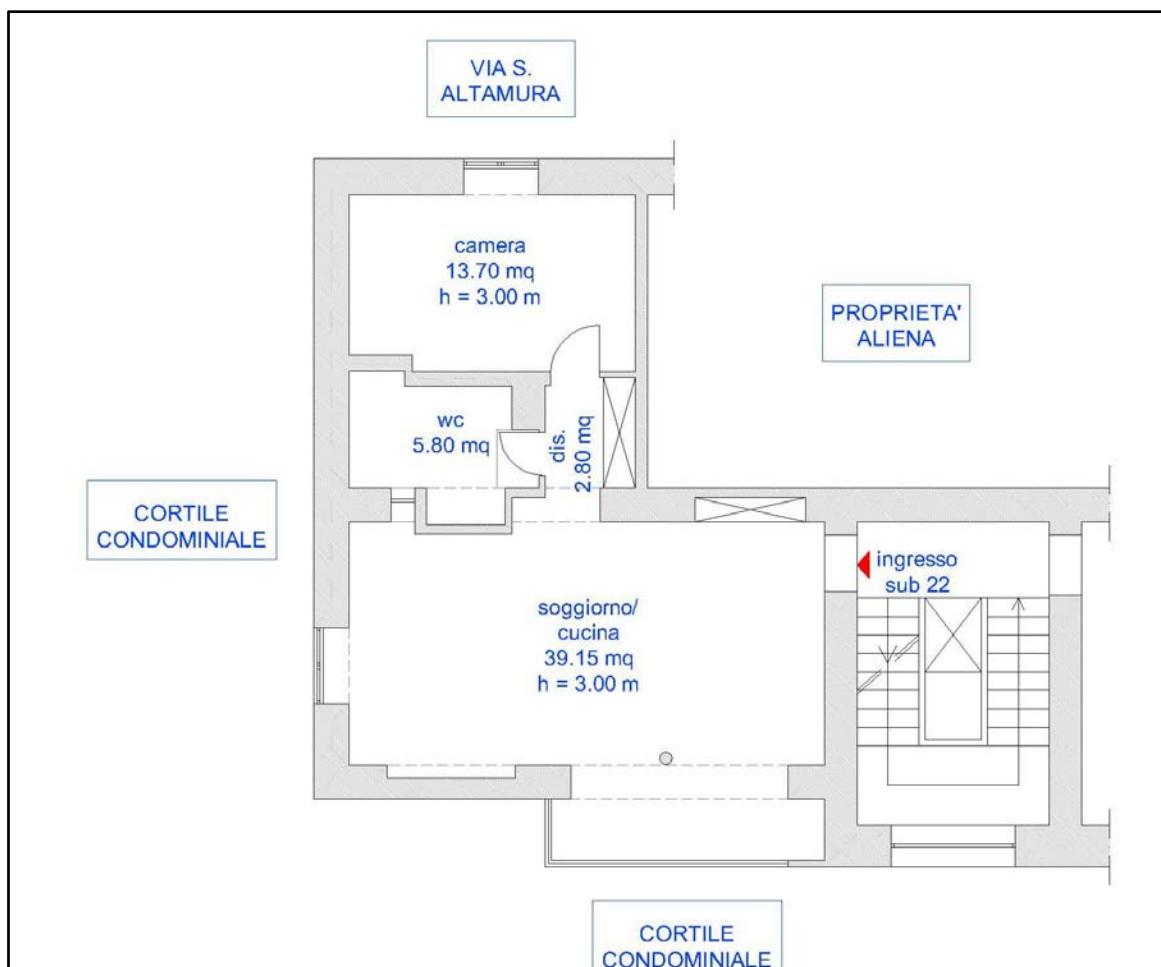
Planimetria stato dei luoghi del sub 22 del 11/12/2020
